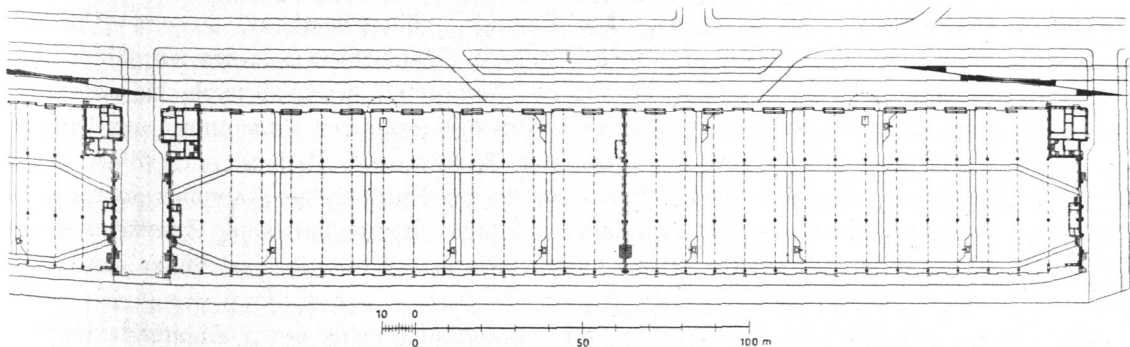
Kaischuppen 53 am Bremer Kai, Grundriß.
